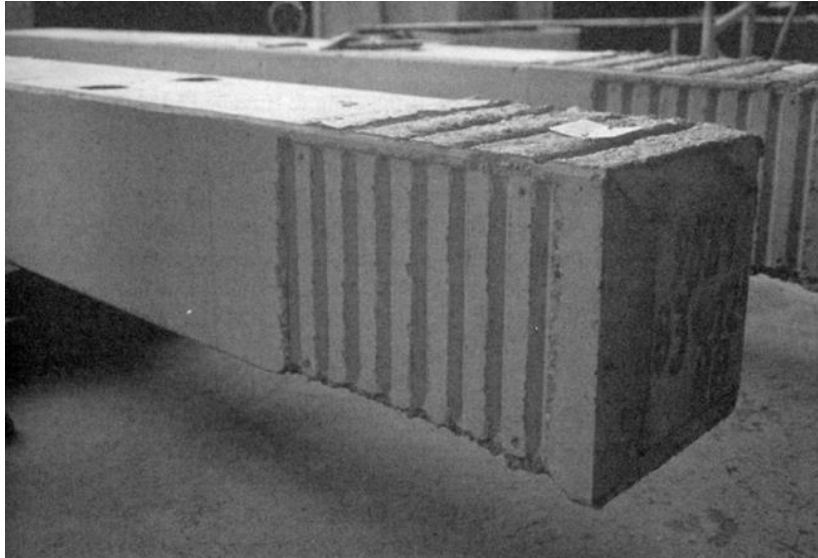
Castellations sur les faces du poteau pour fondations en alvéole [36].
